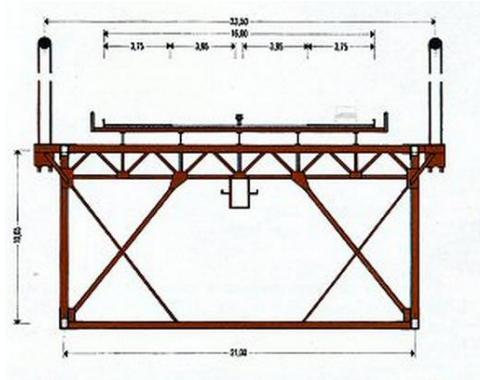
Secção transversal da viga de rigidez antes do reforço estrutural (1966).[16]
